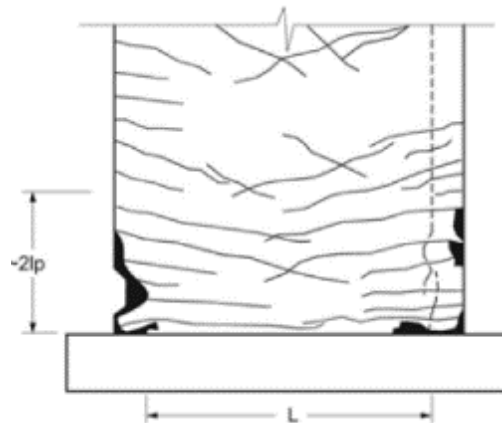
Esquema muro daño nivel IV con aplastamiento en los bordes [7]
